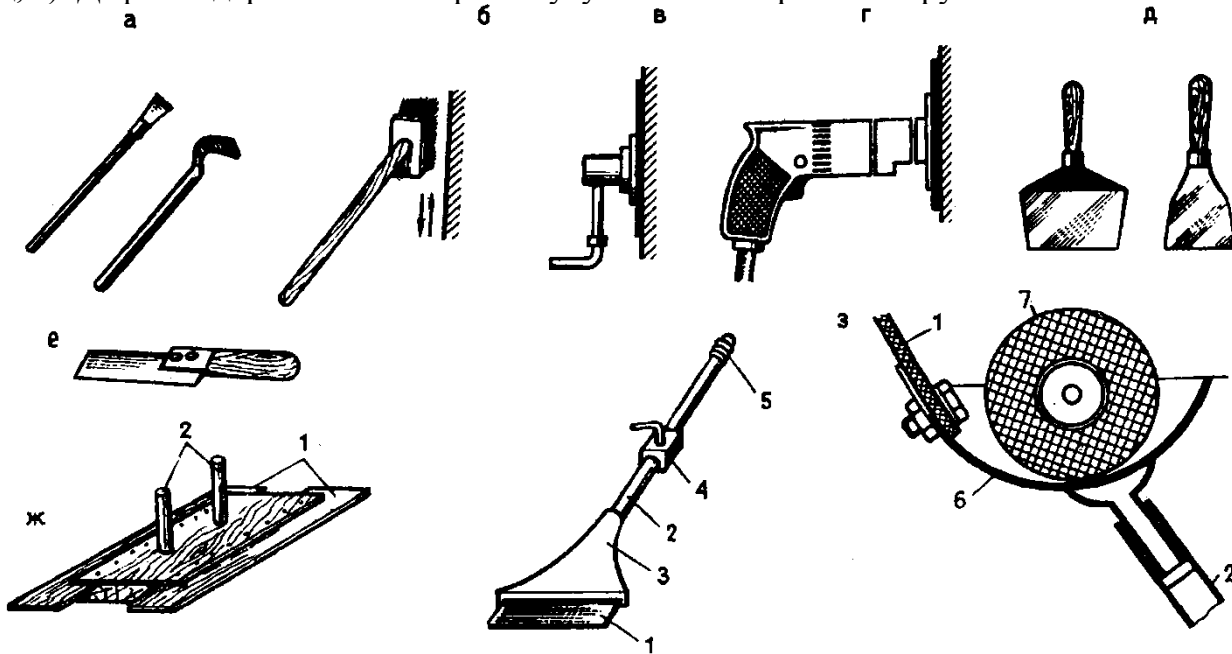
Інструмент для підготовки поверхонь під фарбування:
